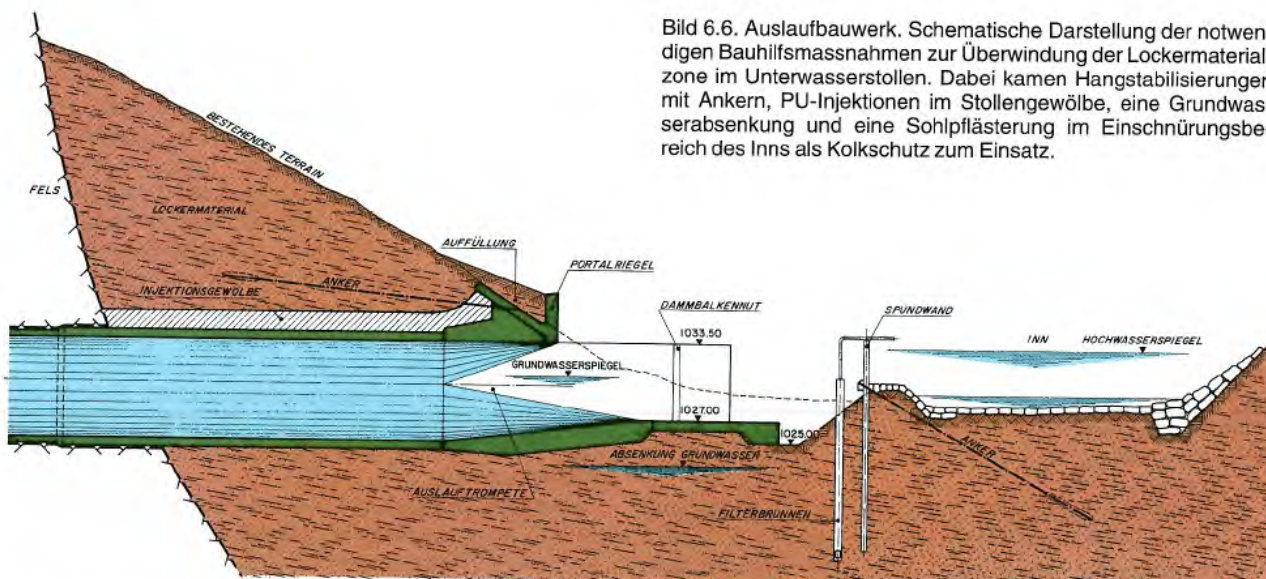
Auslaufbauwerk. Schematische Darstellung der notwendigen Bauhilfsmassnahmen zur Überwindung der Lockermaterialzone im Unterwasserstollen. Dabei kamen Hangstabilisierungen mit Anker, PU-Injektionen im Stollengewölbe, eine Grundwasserabsenkung und eine Sohlplästerung im Einschnürungsbe-
